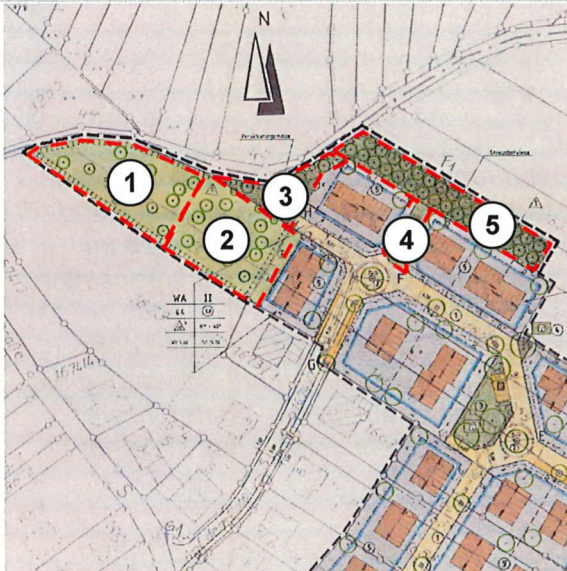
Bebauungsplan „Rötel II“, in der Fassung vom 18.12.2000 mit Übersicht der zeichnerischen Änderungen
